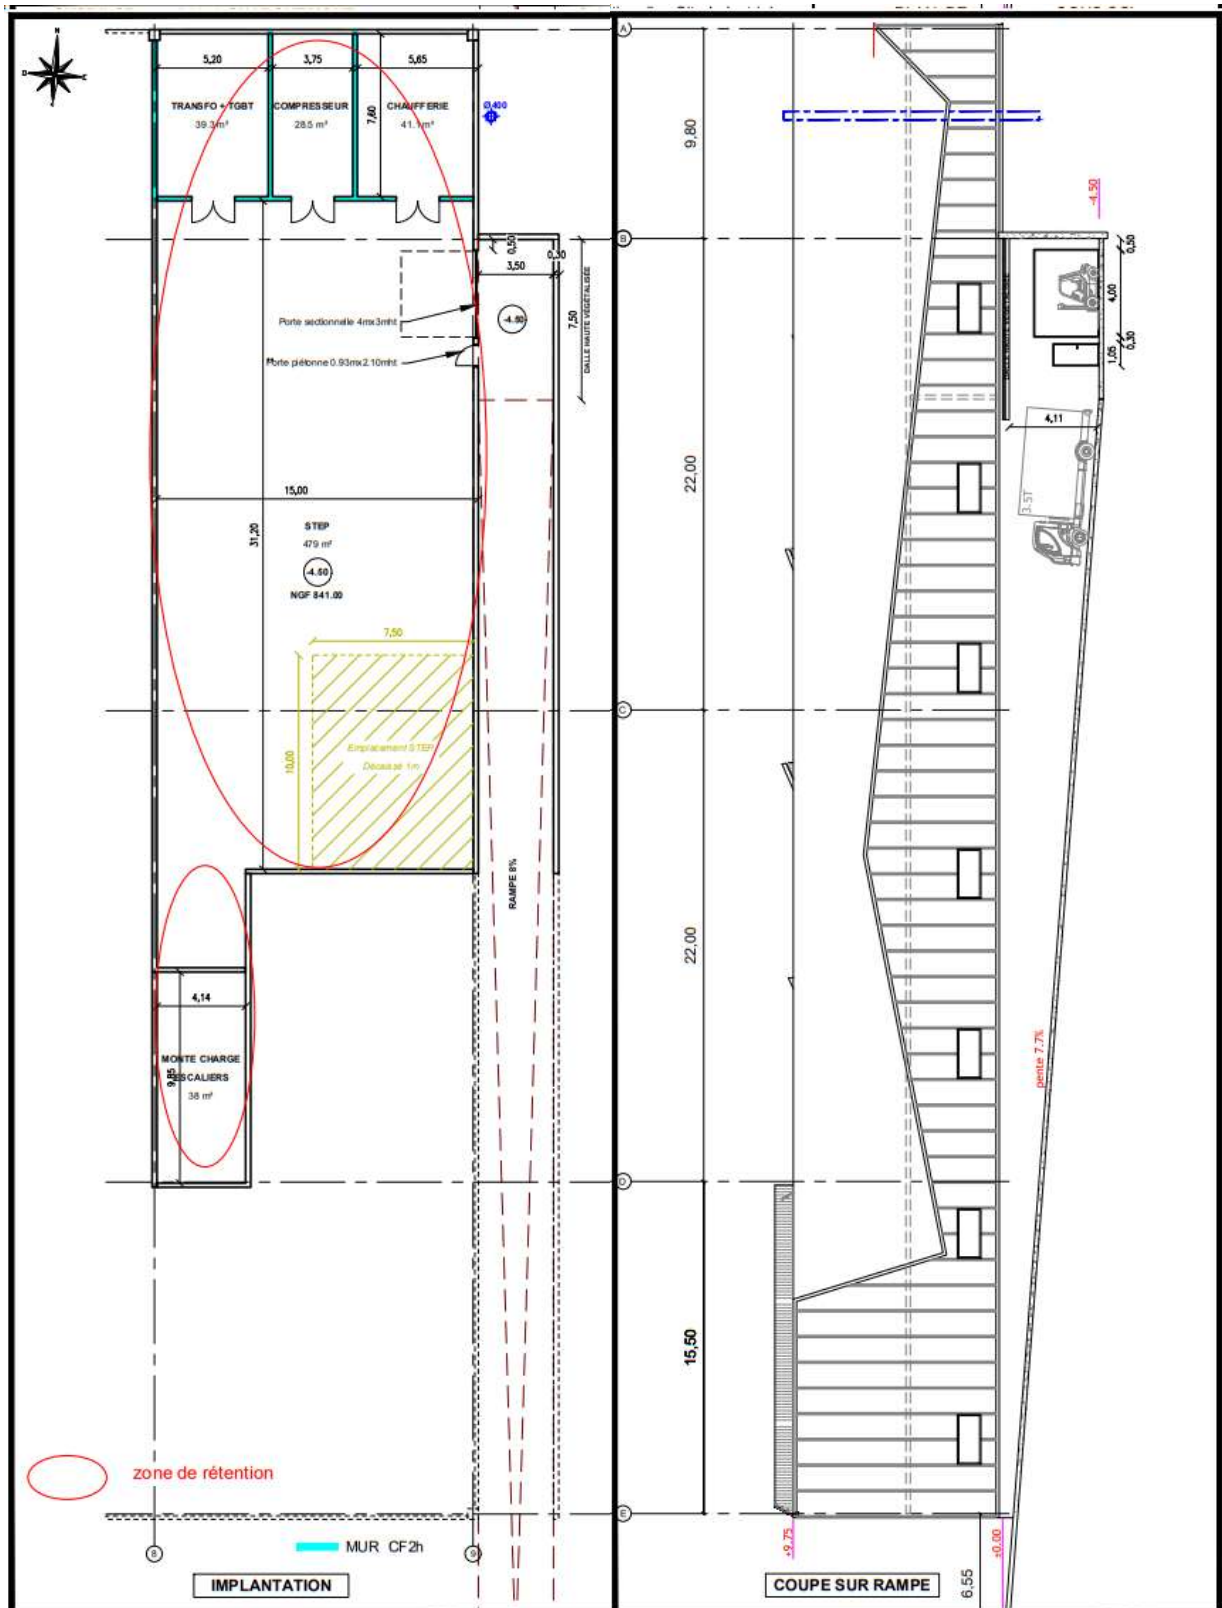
PLAN D'IMPLANTATION DU SOUS-SOL + COUPE SUR RAMPE
